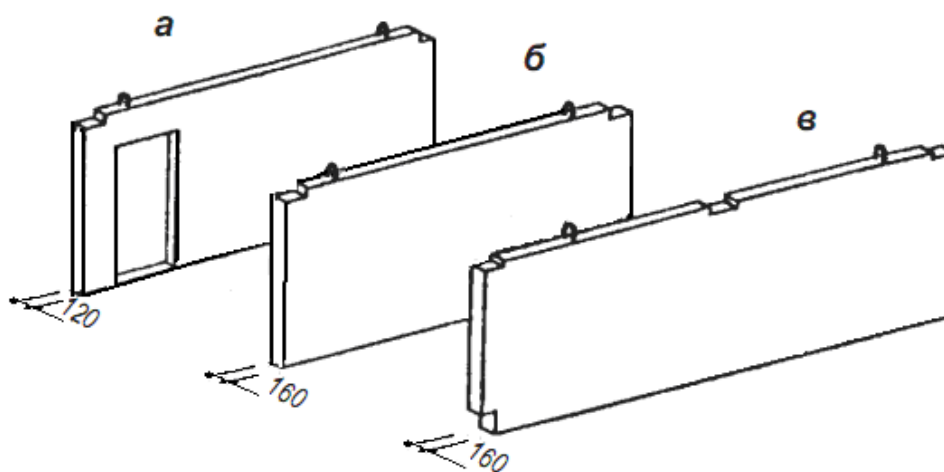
Панелі внутрішніх стін: а – поперечна міжкімнатна; б – те ж міжквартирна; в – повздовжня міжквартирна
